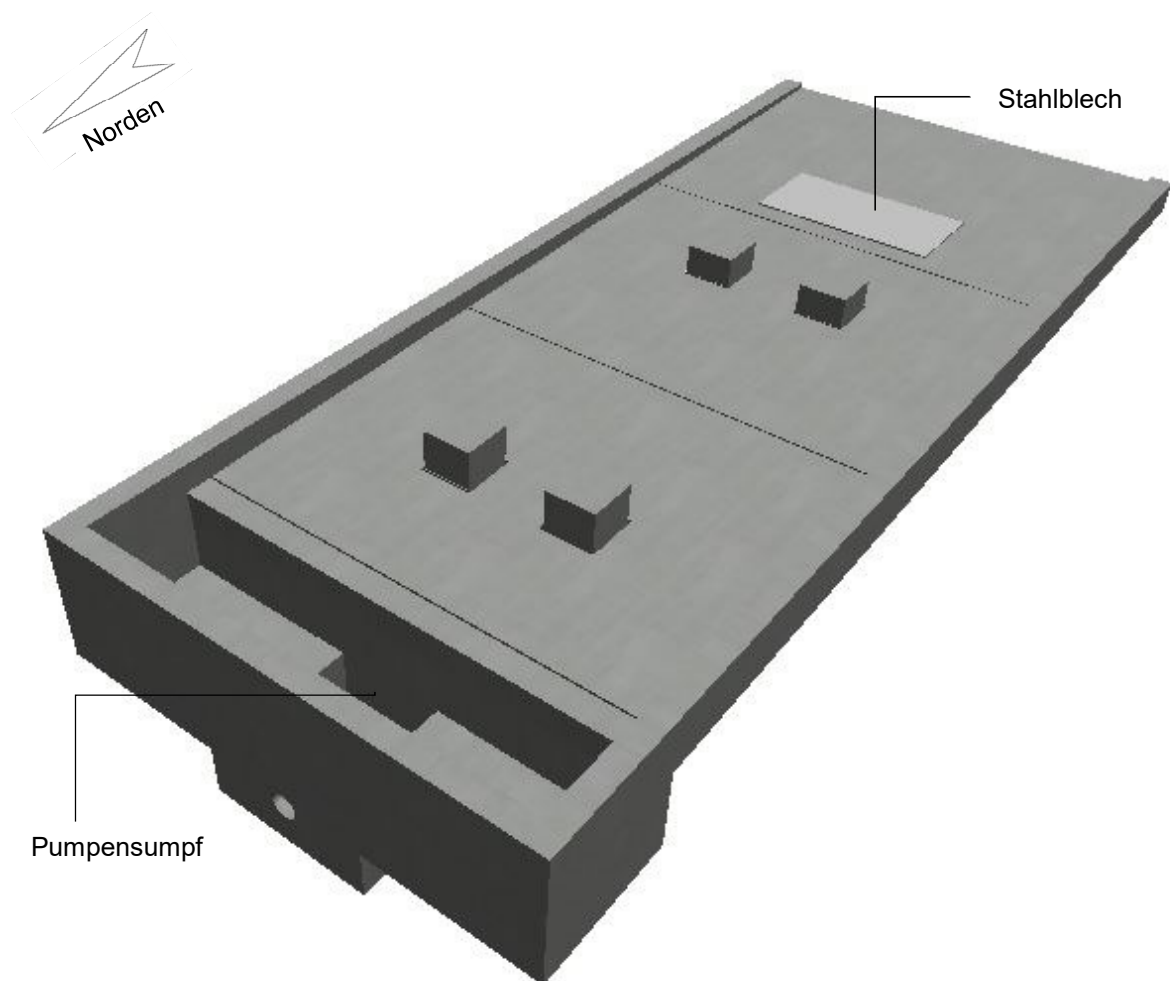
Visualisierungsansicht einer fiktiven Rückhalteeinrichtung aus unbeschichtetem Beton (Erstellt mit mb Worksuite 2017 Vicado – Studentenversion)
